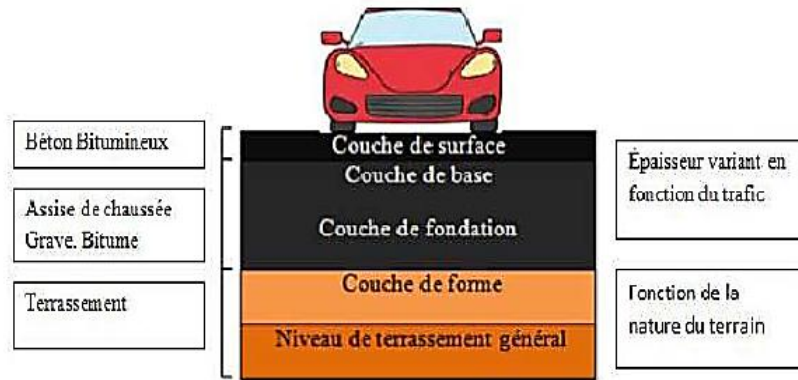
Structure type d'une chaussée souple. (LCPC, 1994)
